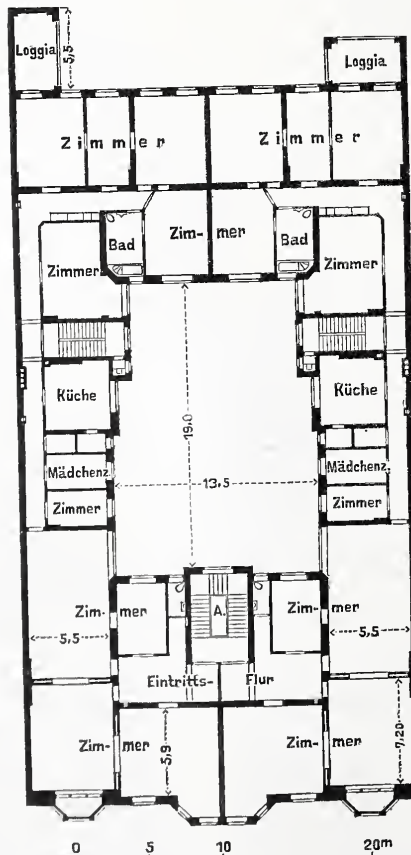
Grundriss vom I. u. II. Stock.
